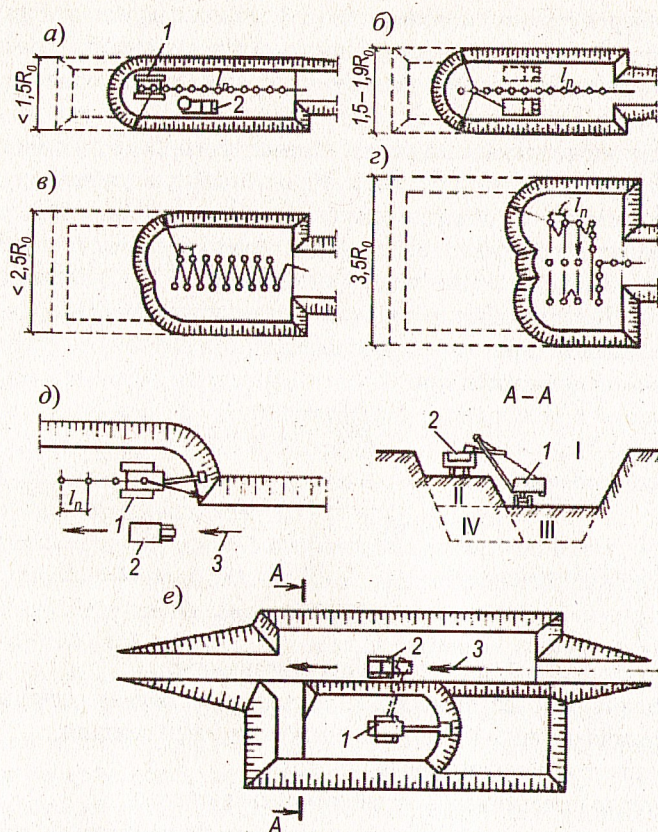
Схема экскаваторных проходок с прямой лопатой: а — лобовая (торцевая) проходка; б — то же, с двусторонним расположением транспорта; в — уширенная лобовая проходка с движением экскаватора «зигзаг»; г — поперечно-торцевая проходка; д — боковая проходка; е — разработка котлована по ярусам; I, II, III, IV — ярусы разработки; 1 — экскаватор; 2 — самосвал; 3 — направление движения транспорта
